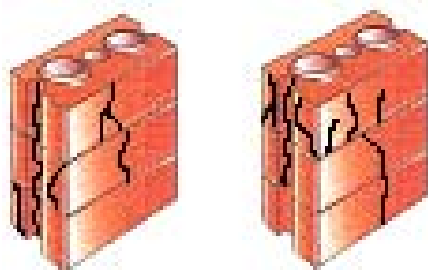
Fissuras no final do ensaio dos prismas-tipo e, sem argamassa de injeção
